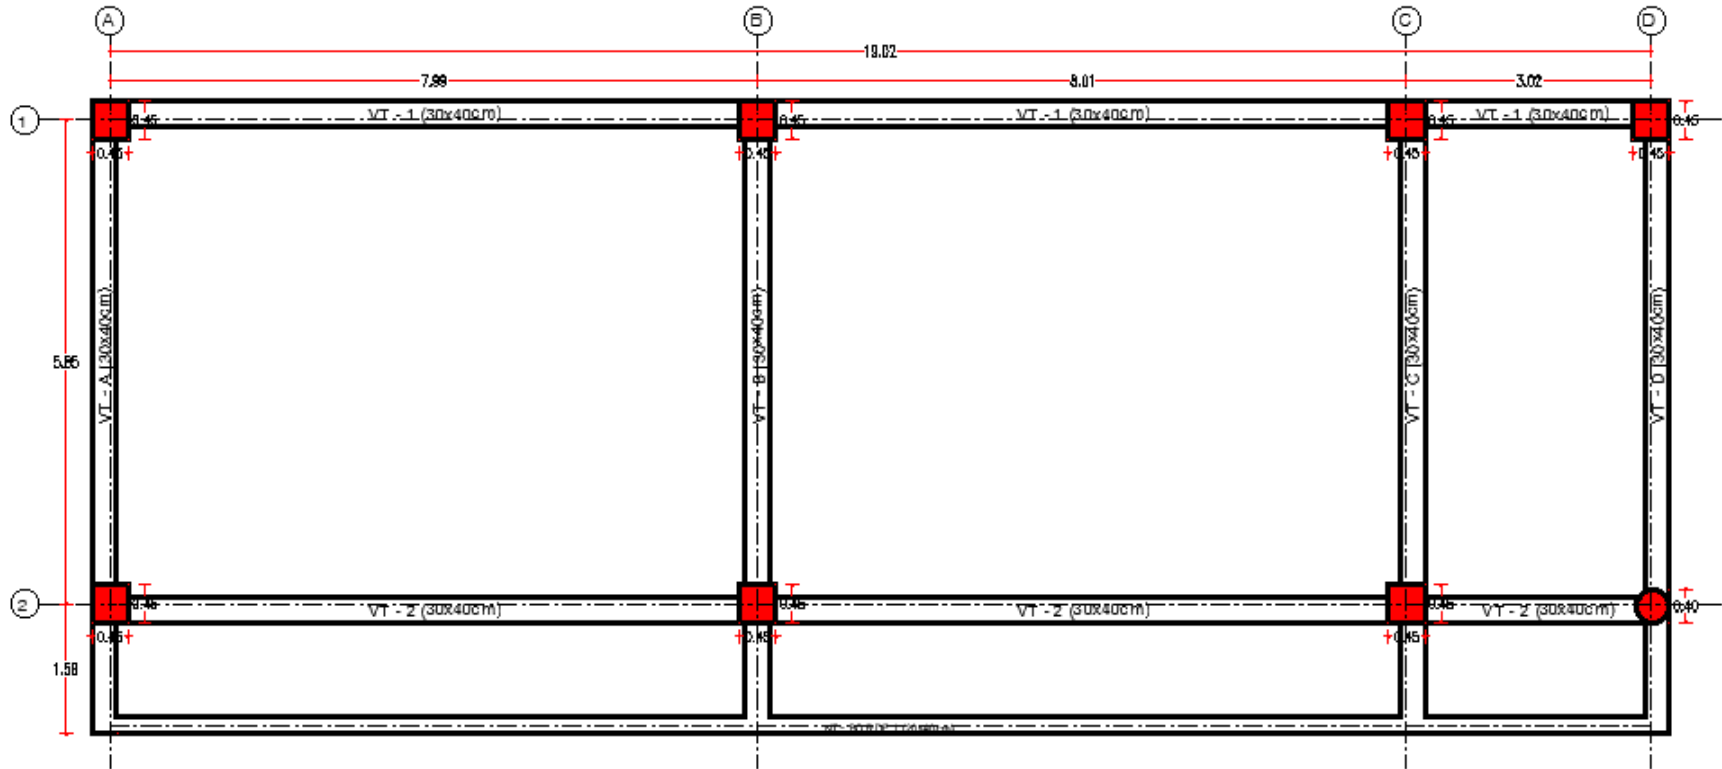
Vista en planta de vigas de cubierta (Elaboración propia).
